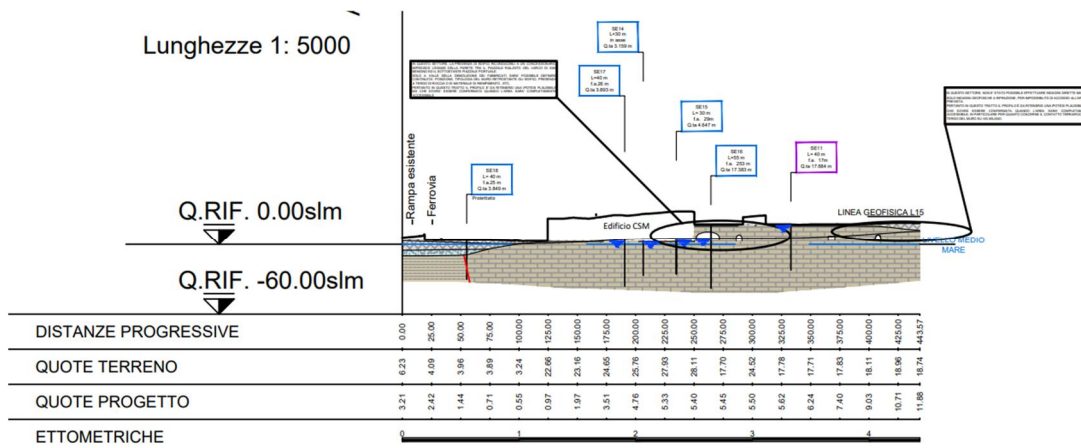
Stralcio del profilo geologici nella zona trasversale ai 2 cantieri di interesse
